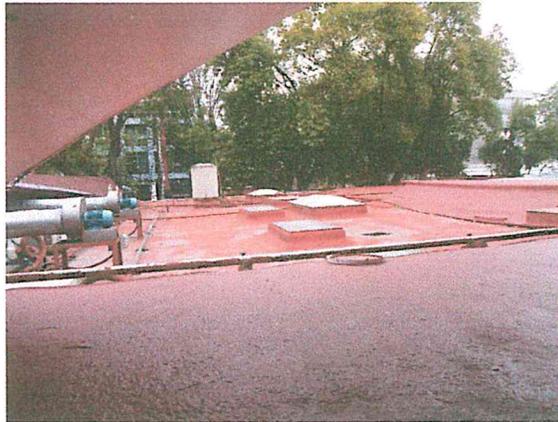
Techumbre de concreto armado en buen estado estructural del cuerpo principal del CENTRO DE REHABILITACION GABY BRIMMER.
